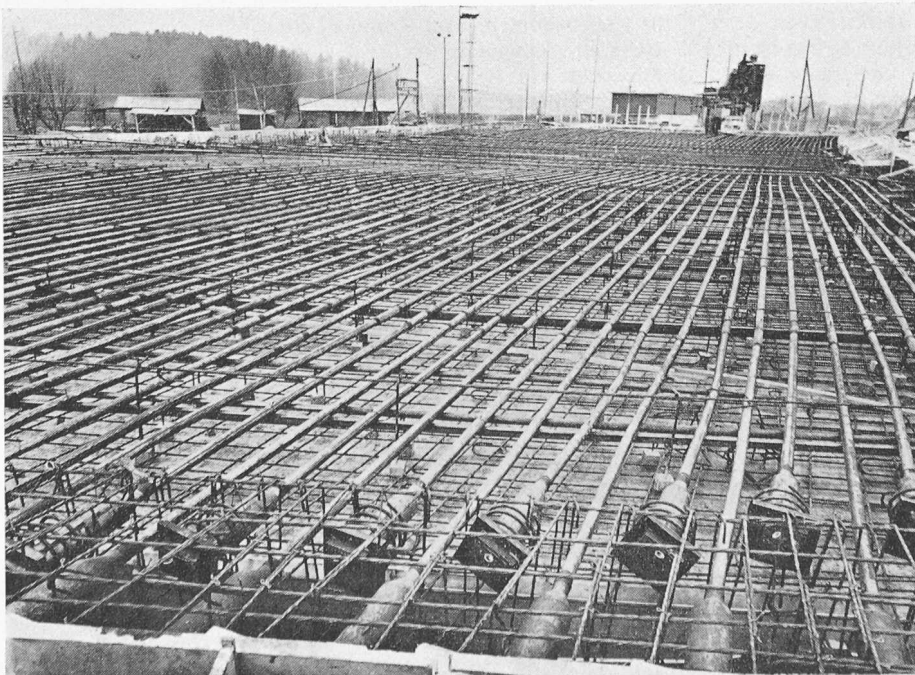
Vorspannkabel und Armierungen vor dem Betonieren
